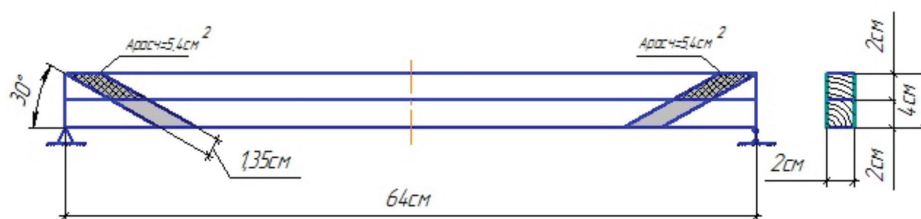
К определению расчетной площади взаимного перекрытия внешнего армирования и половины сечения балки с одной стороны
